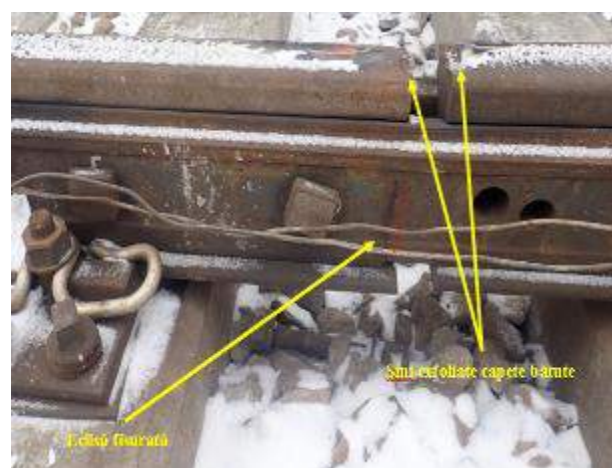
Joanta vârful schimbător fir stâng ext.
